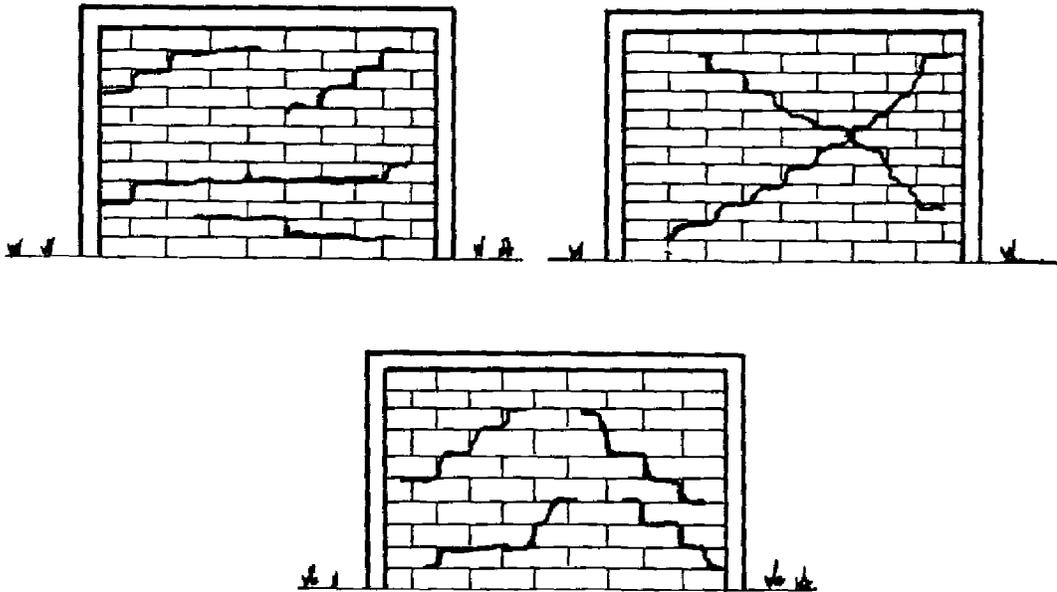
GRIETAS TIPICAS DE ALBAÑILERIA REFORZADA
